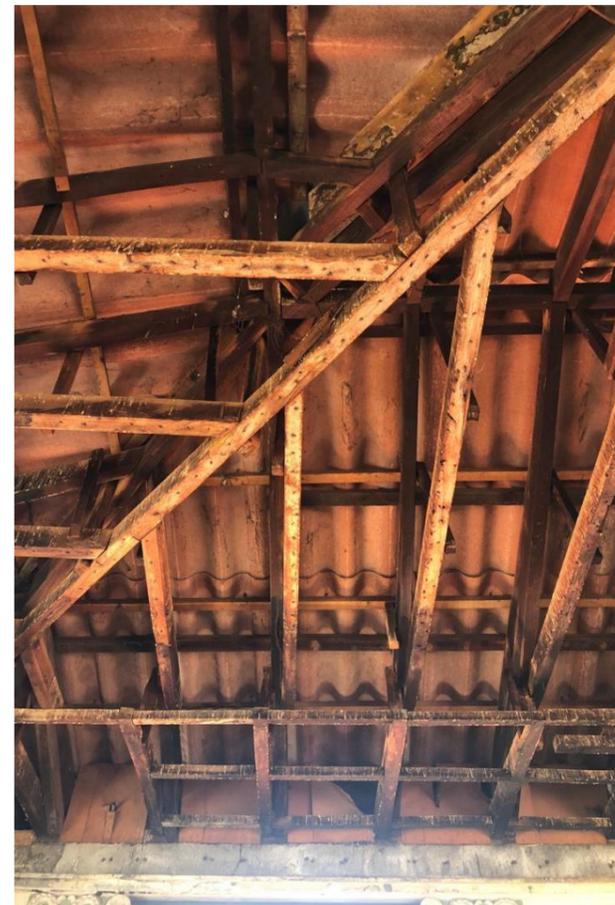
Estructura de techo en tercer nivel. Fuente: propia.
